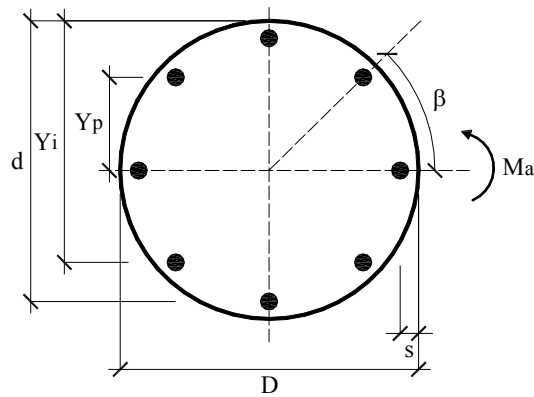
Seção transversal circular com armadura (Ricci, 1995)
